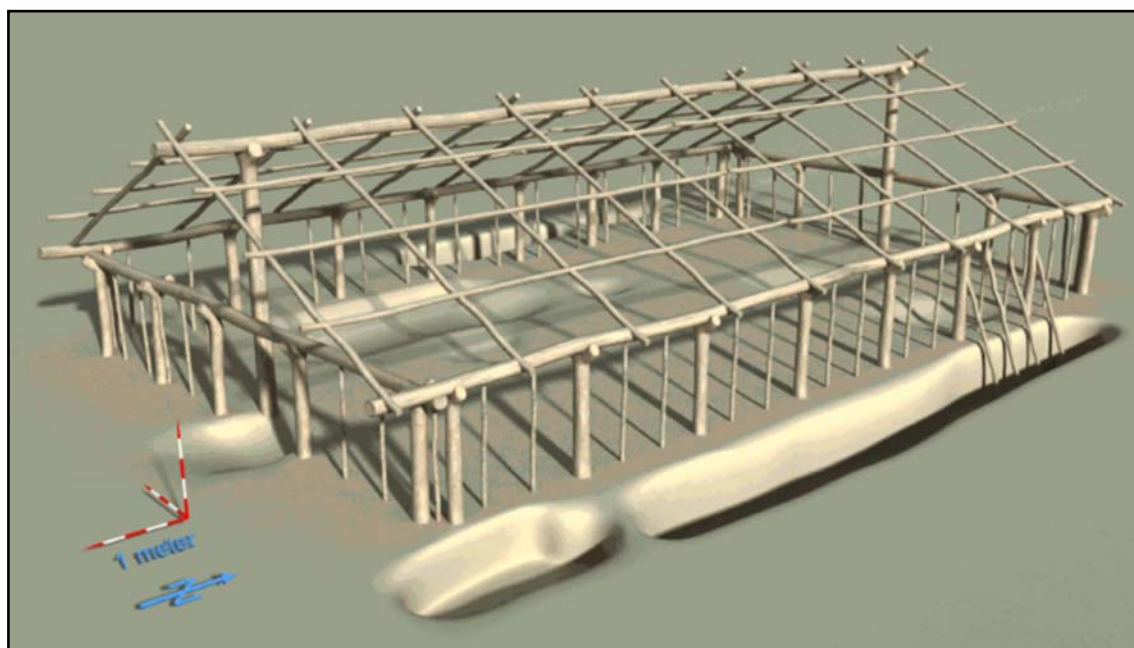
Сентдьёрдвёлдь-Питьердомб. Реконструкция строительства жилища 2.
